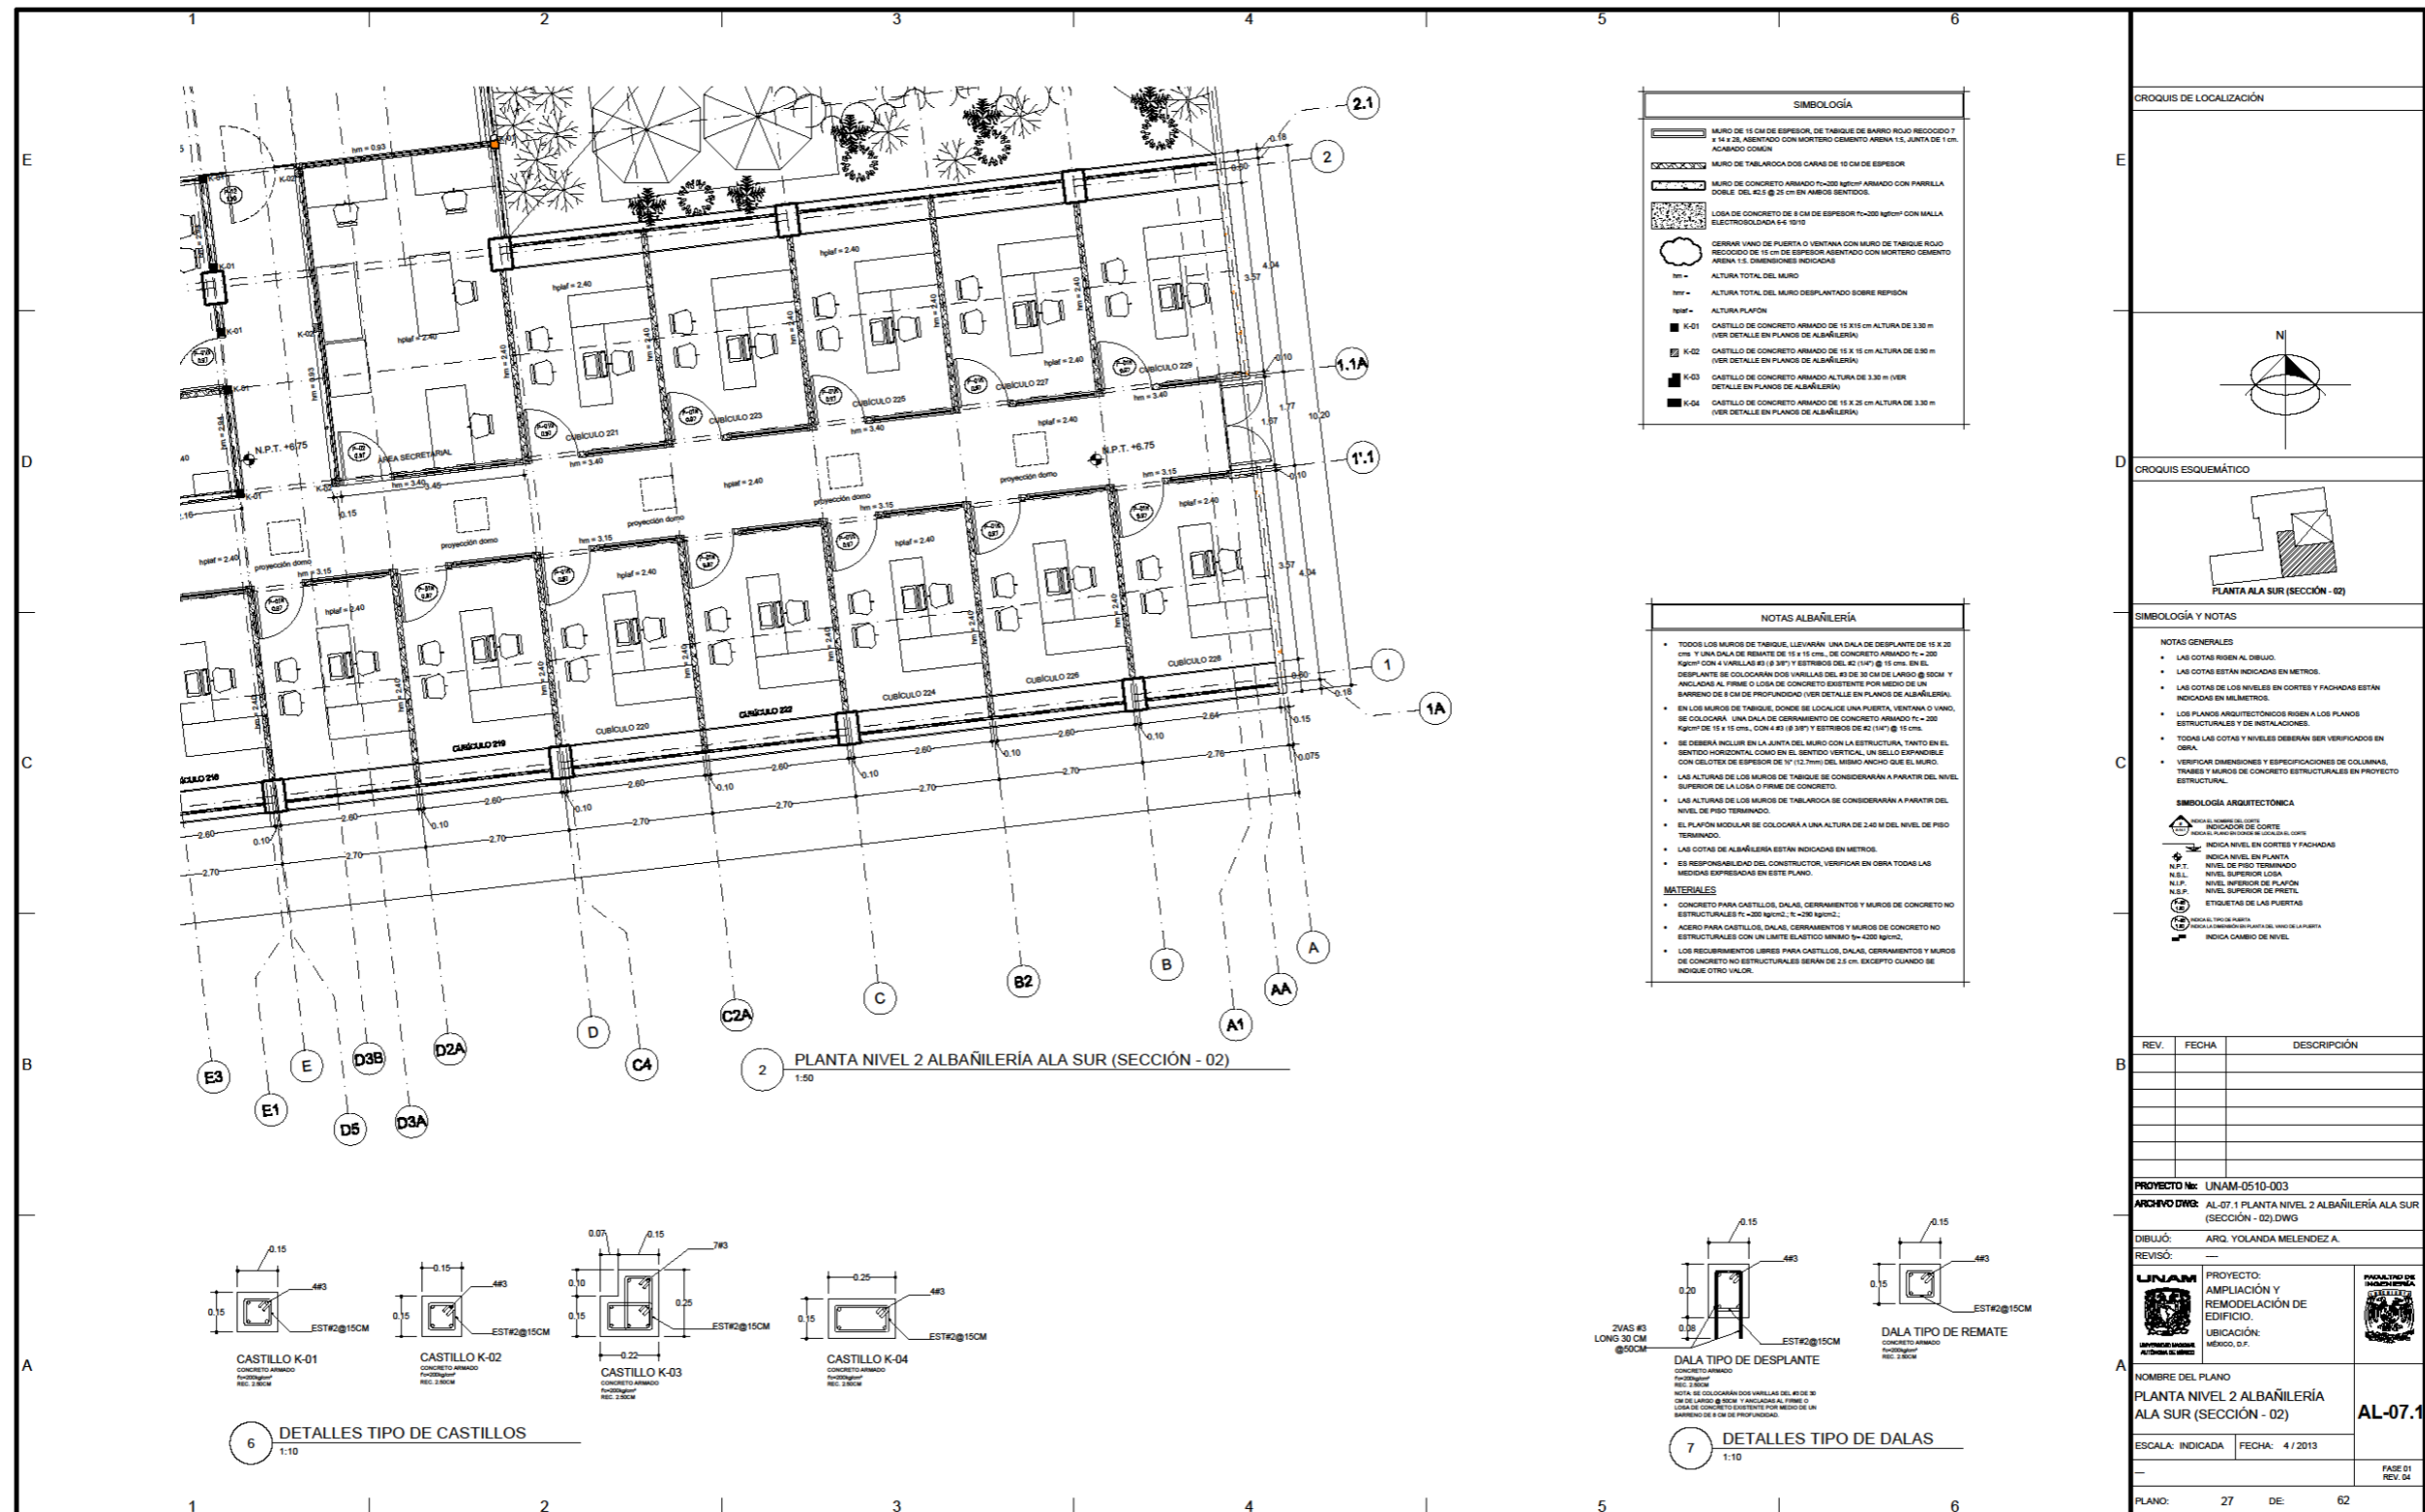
Plano AL-07.1 Planta Nivel 2 albañilería Ala Sur (Sección - 02)
